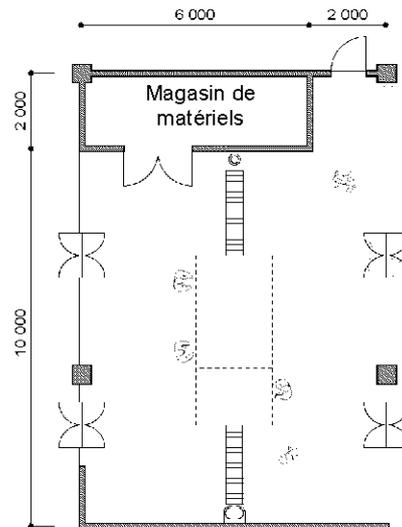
(28) Plan de l'aire de prétraitement de poissons bruts pour salage/séchage
